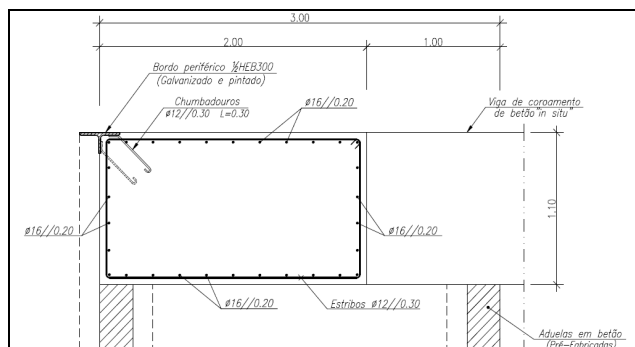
Pormenor construtivo da viga de coroamento do muro-cais (imagem do projecto de execução).
